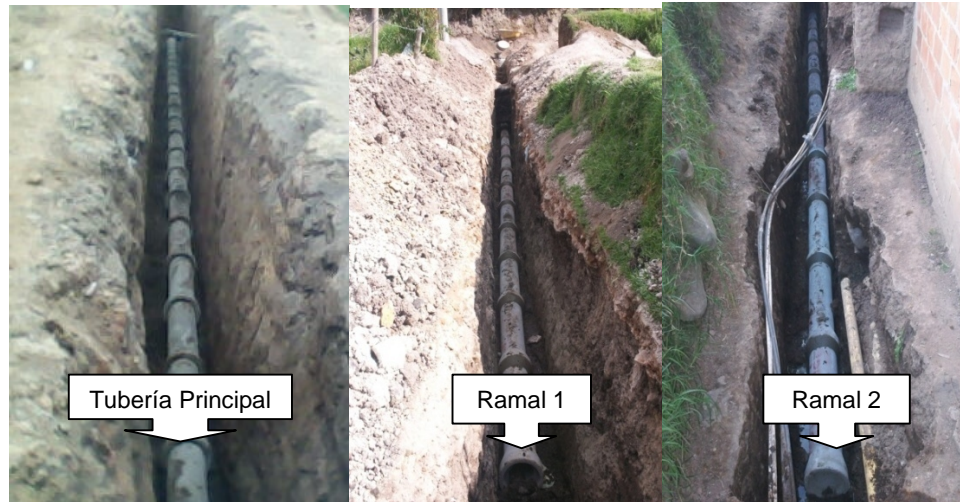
Instalación de tubería alcantarillado sector Pejendino Reyes
